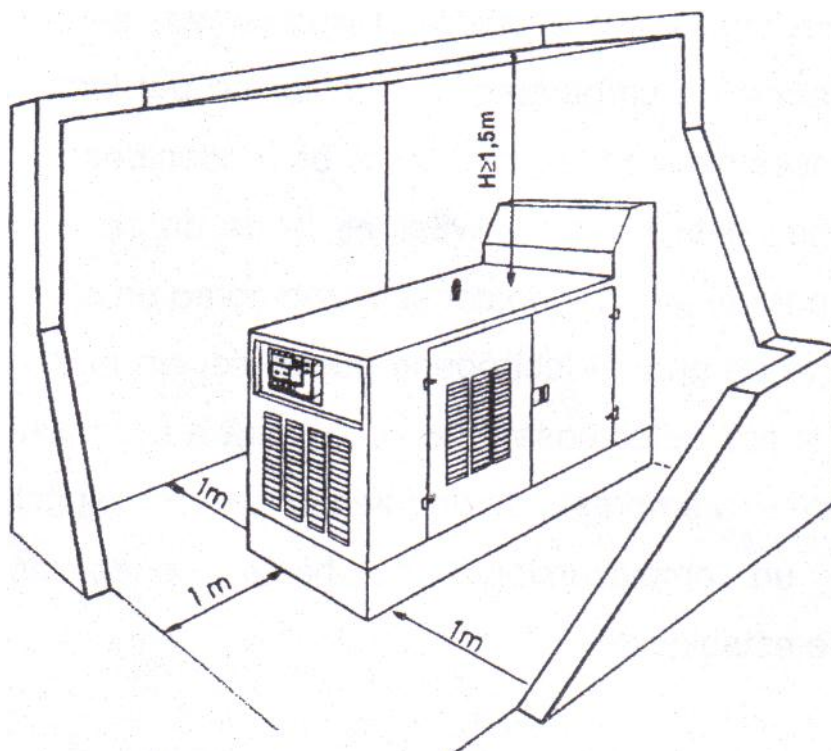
Dimensiones Mínimas para el Montaje de un Grupo Electrónico
